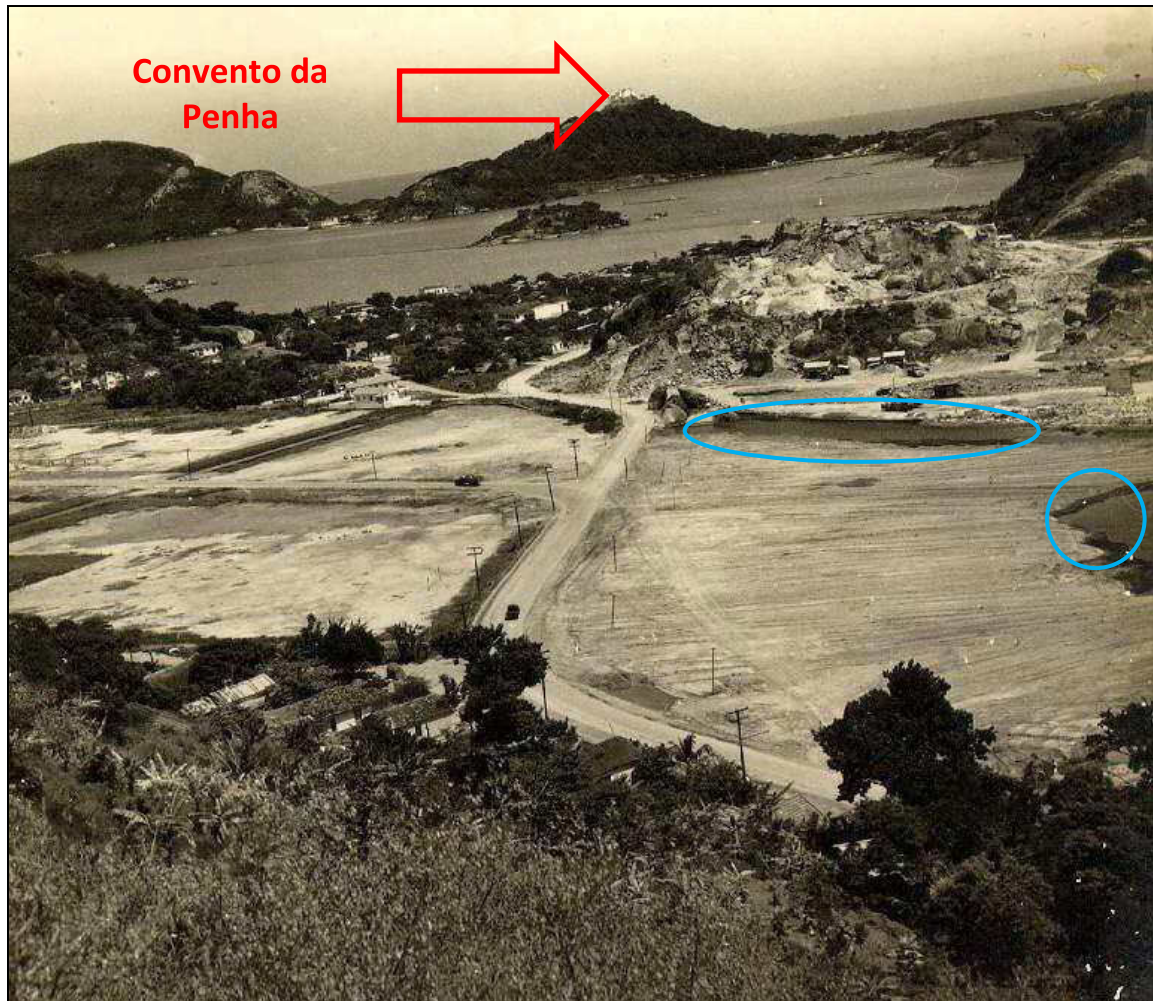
Avenida Leitão da Silva; aterro para construção do Bairro Praia do Suá.
